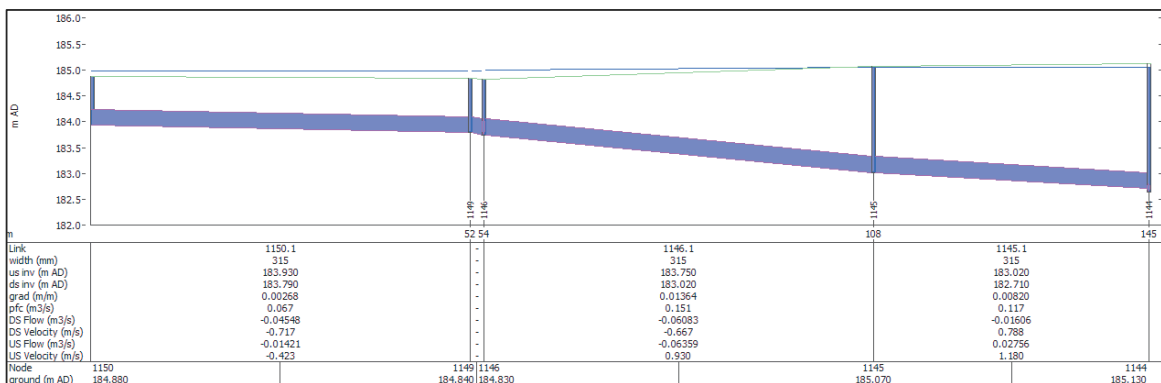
Profilo idraulico su tratto di via Adige allagamenti cameretta 1146, 1149 e 1150.
